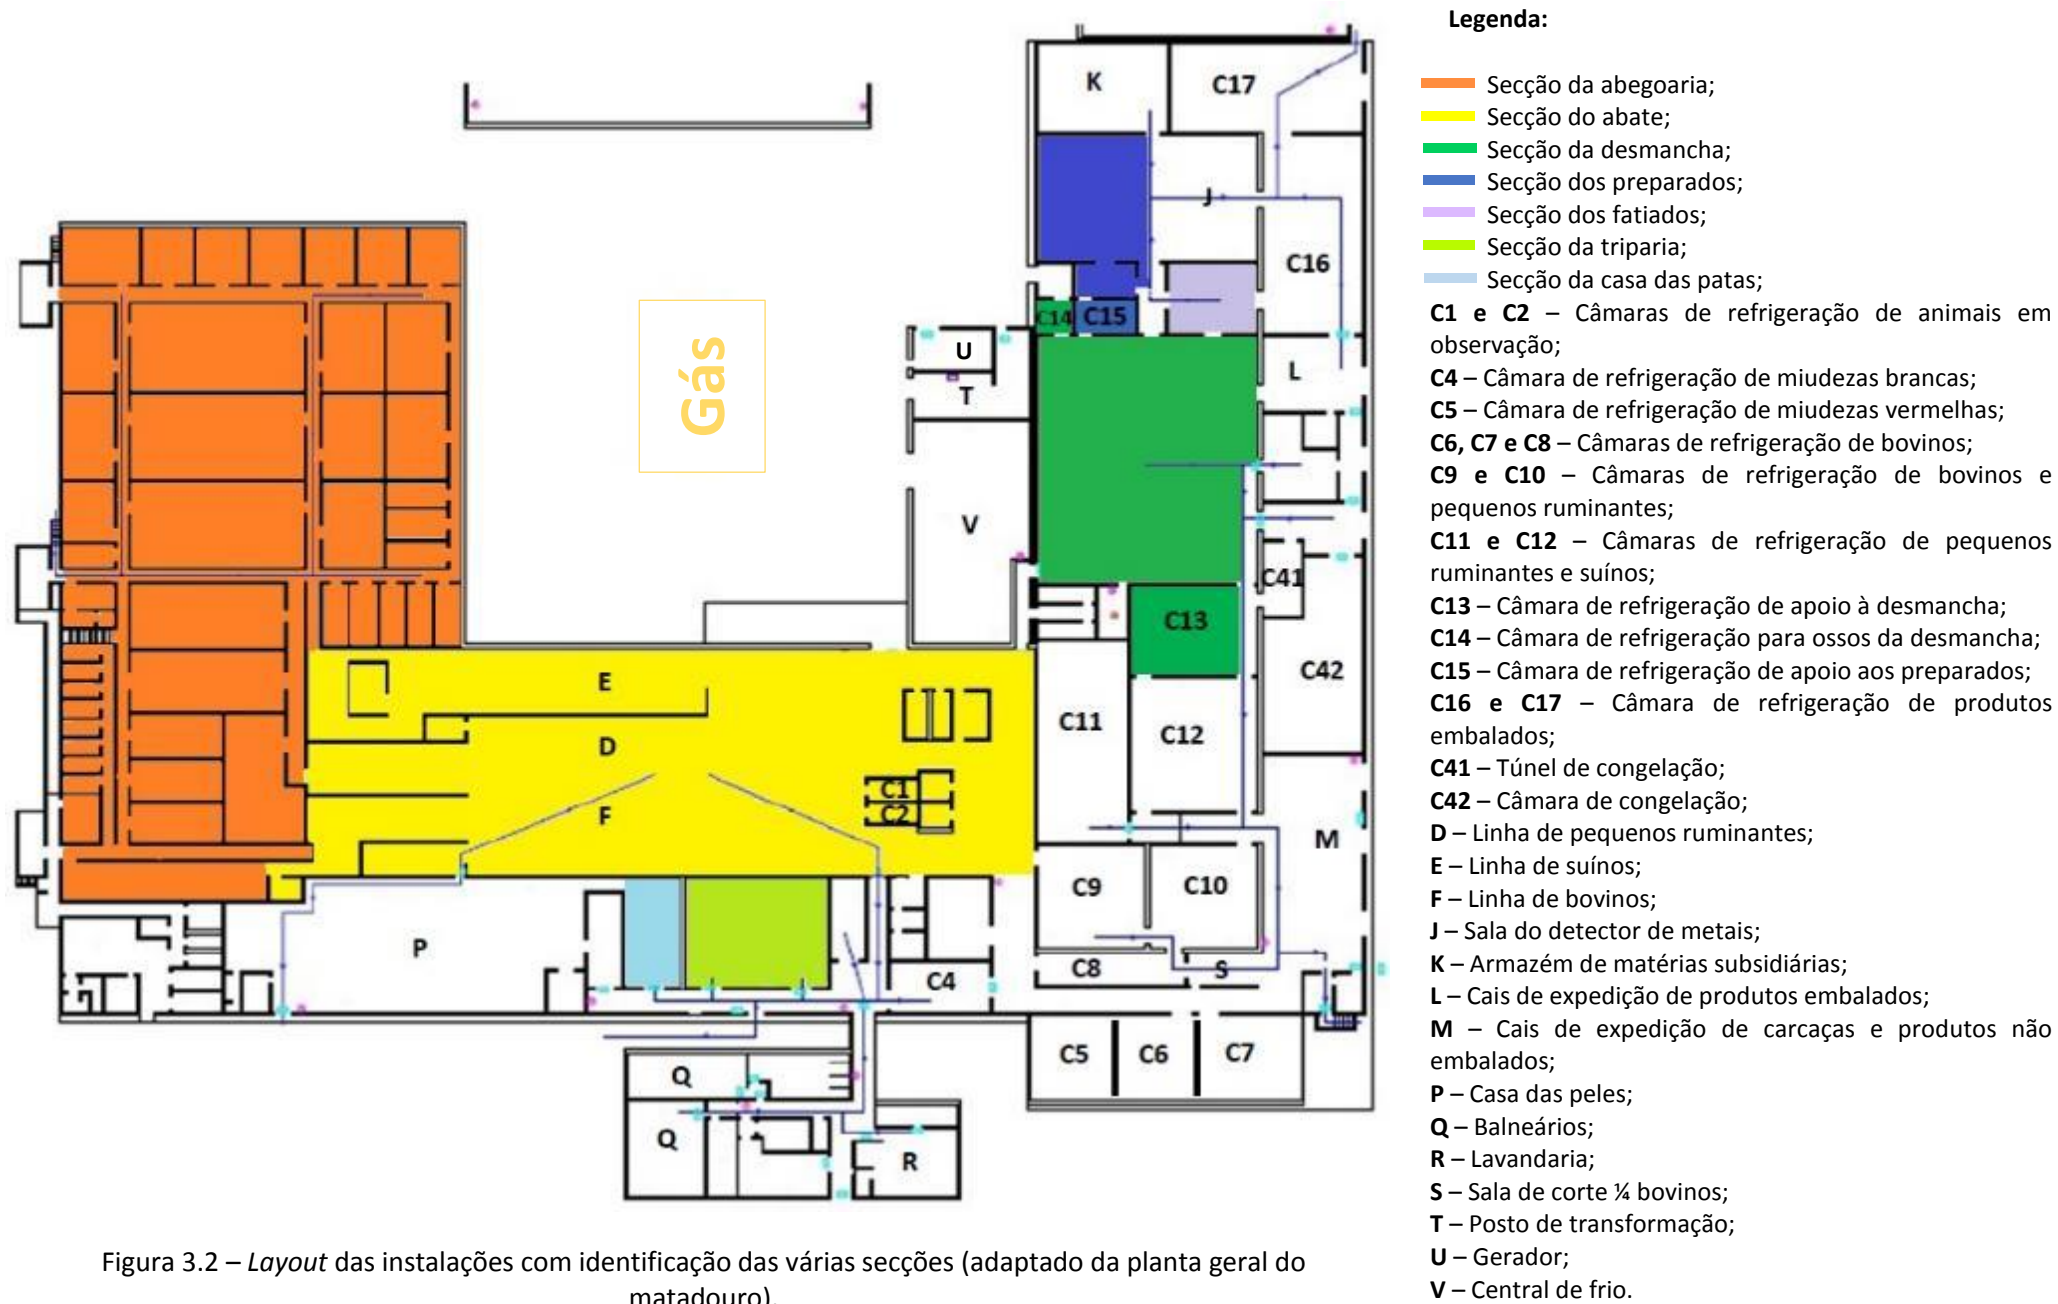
Layout* das instalações com identificação das várias secções (adaptado da planta geral do matadouro).
